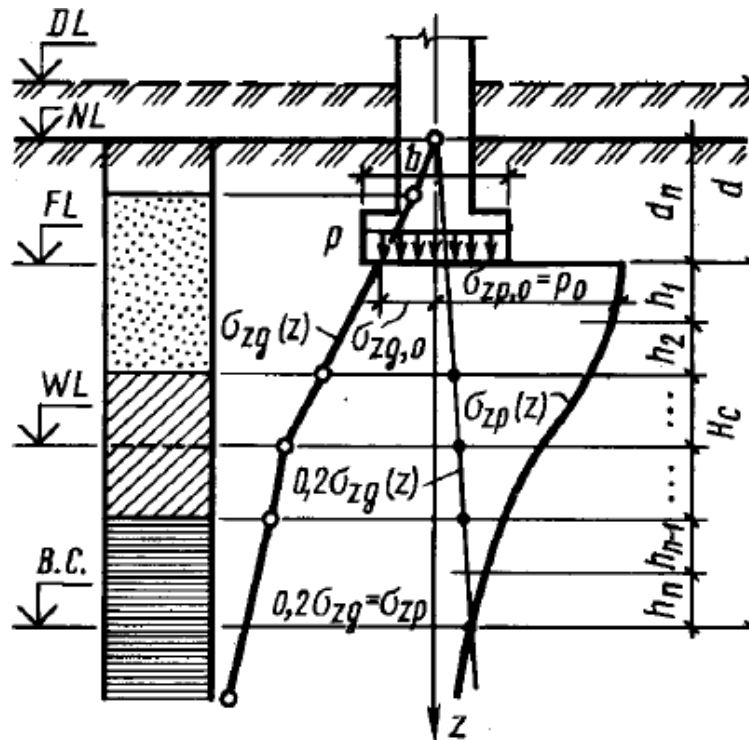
Схема к расчету осадки фундамента методом послойного суммирования:
